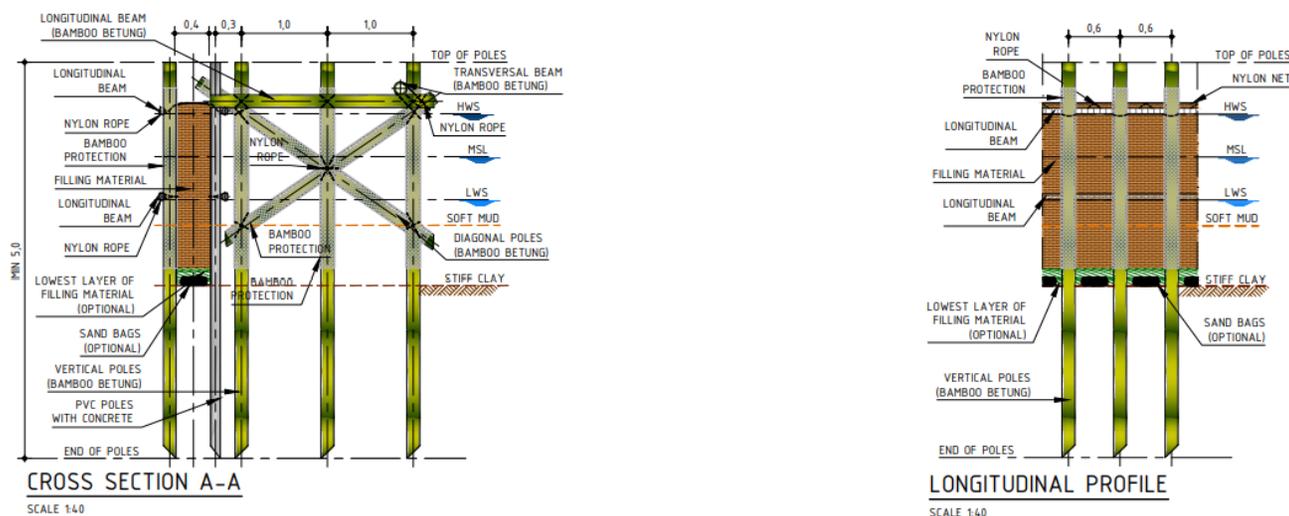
Esquema de la estructura de pilotes. Fuente: Permeables Structures, 2020 © Joost Fluitsma – JAM Visual Thinking.
